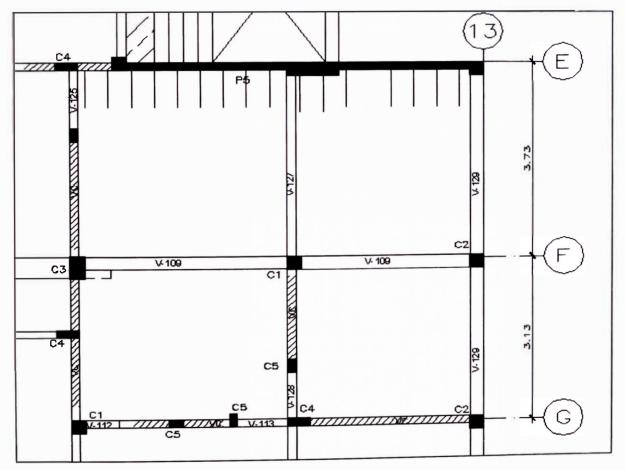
Esquema de los tramos de la viga V-109
